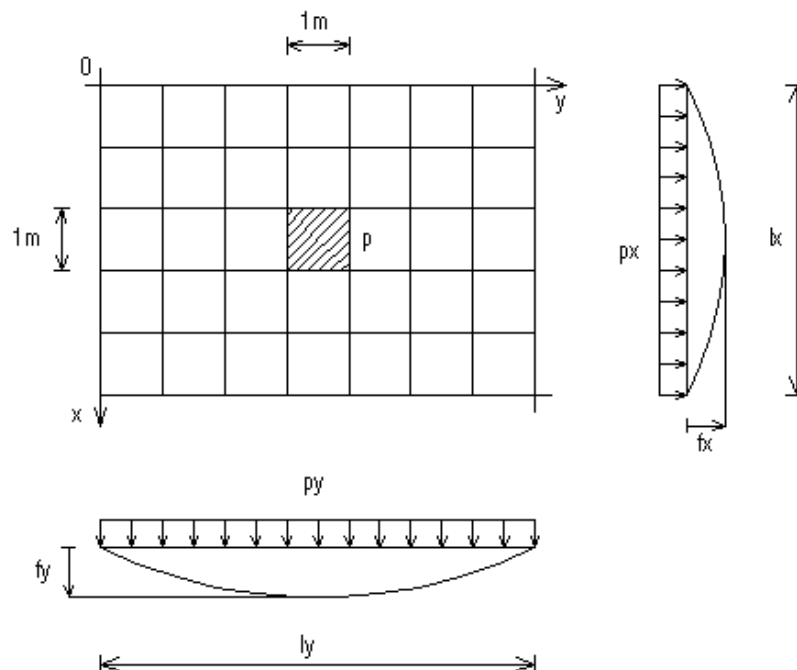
Laje simplesmente apoiada nos 4 lados.
